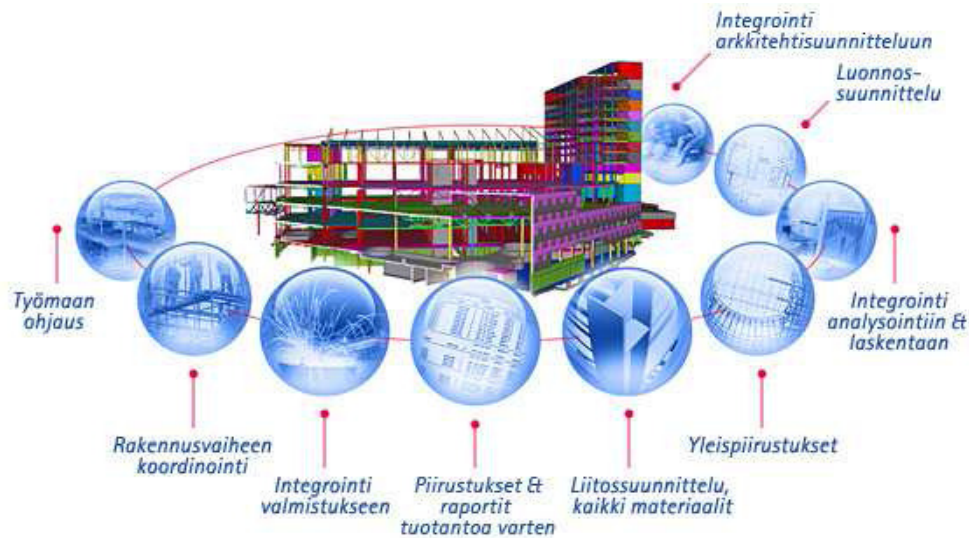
Eri ohjelmistokokoonpanojen detailjiesimerkkejä
